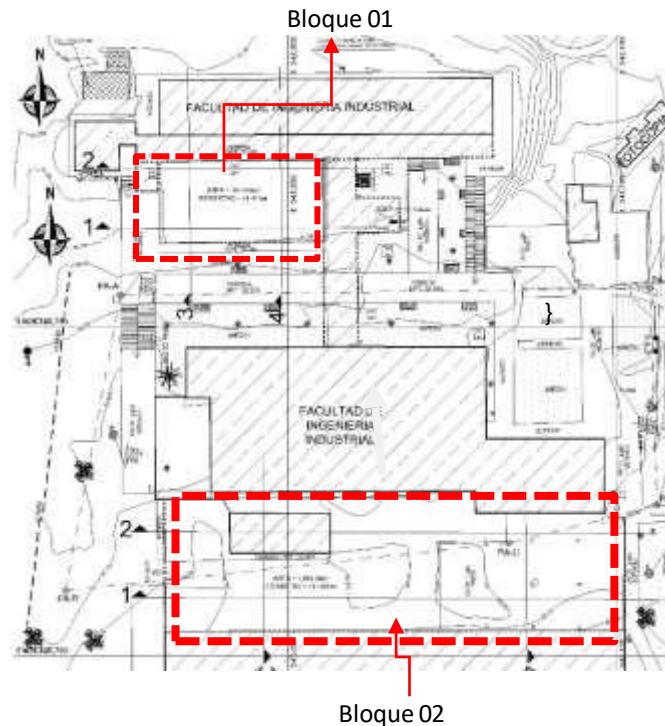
Ubicación las áreas construidas y Proyectadas en Bloques 1 y 2
